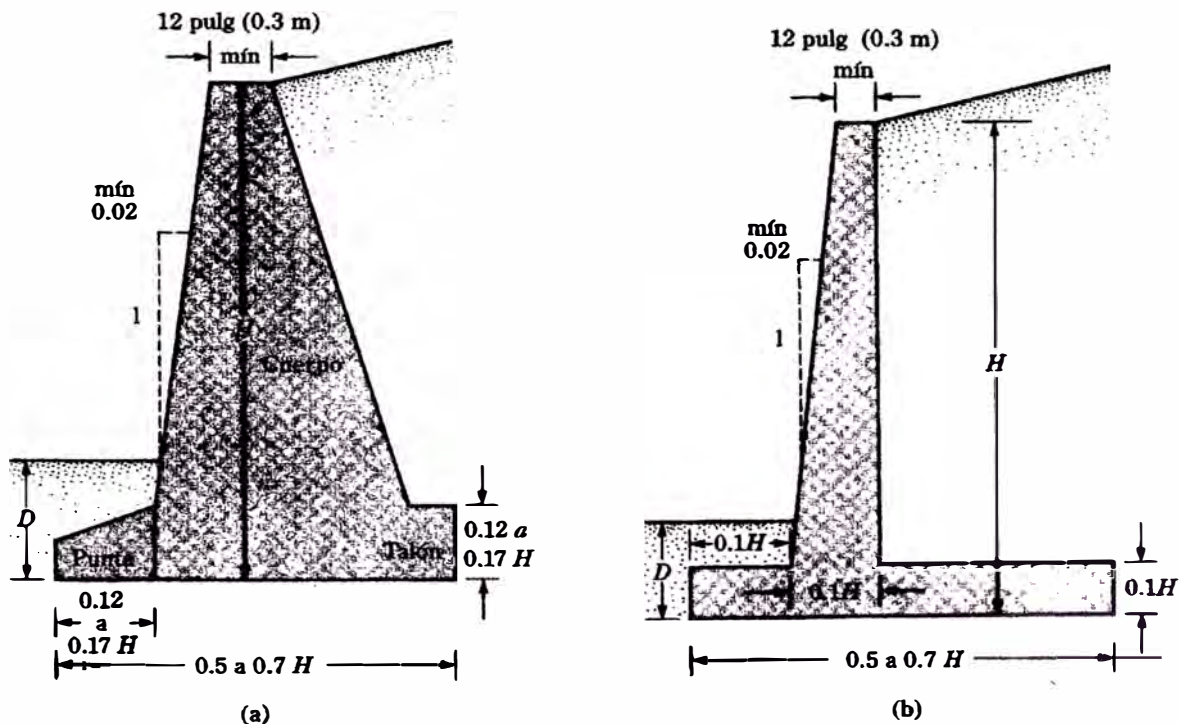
Pre dimensionamiento de Muros de Contención: (a) Muro de Gravedad y (b) Muro en Voladizo
